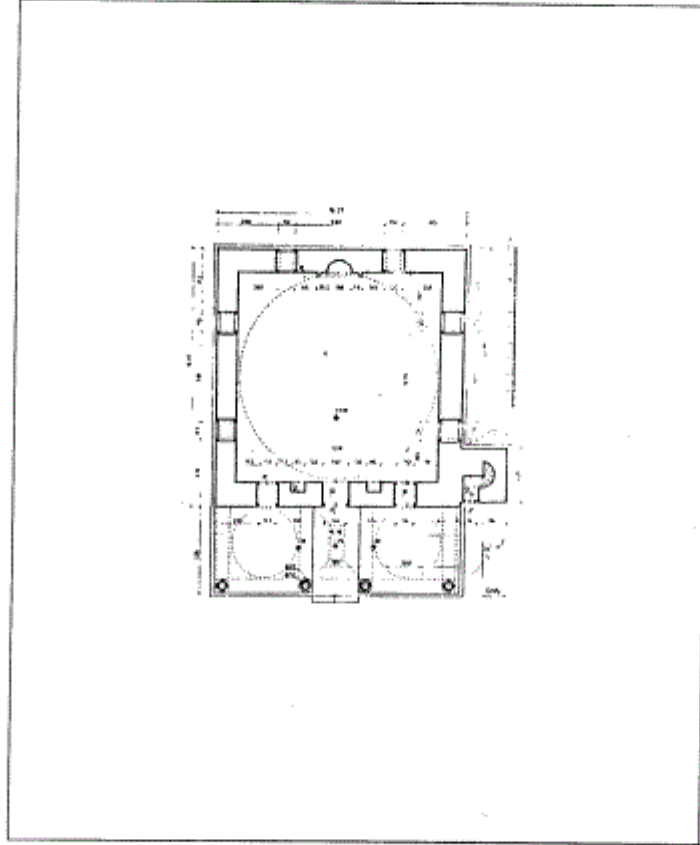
مسقط أفقي لمسجد ستي خاتون في أدرنة (عن : اصلان ابا) .
